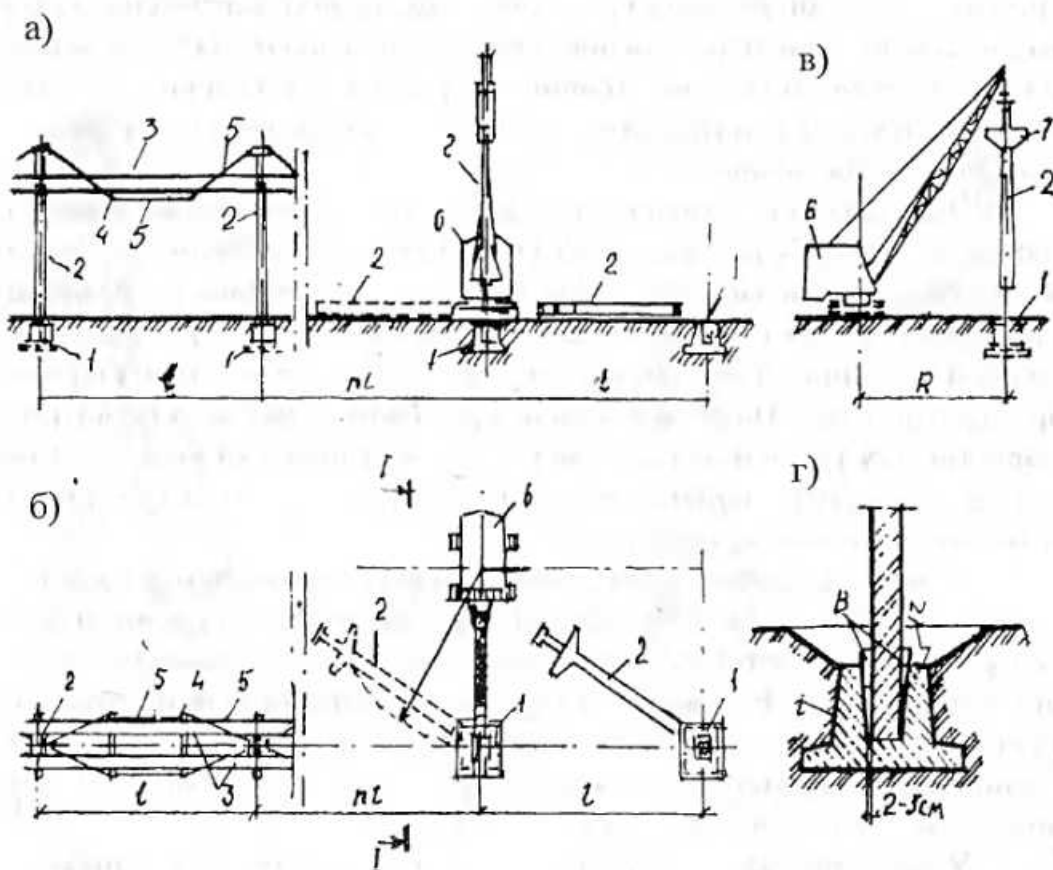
Монтаж залізобетонних стійок для надземного прокладання трубопроводів: а) вигляд збоку; б) план, в) розріз I-I; г) встановлення стійки в стакан фундаменту; 1-залізобетонний фундамент; 2-хрестоподібна залізобетонна стійка; 3-трубопроводи; 4-підвісні балки; 5 - ванти; 6 - стріловий кран; 7-рамковий захоплювач; 8-клини
